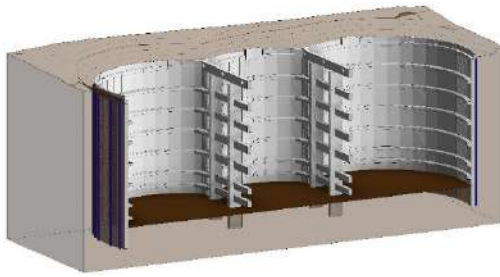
Corte longitudinal da estrutura do reservatório após toda a escavação do interior e execução dos anéis e Escoras.
